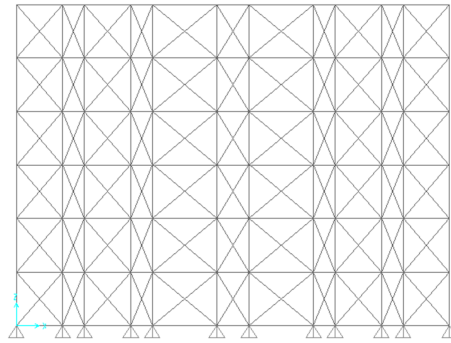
Configuração dos Planos de Contraventamento Vertical Com Elementos de Contraventamento Pequenos
